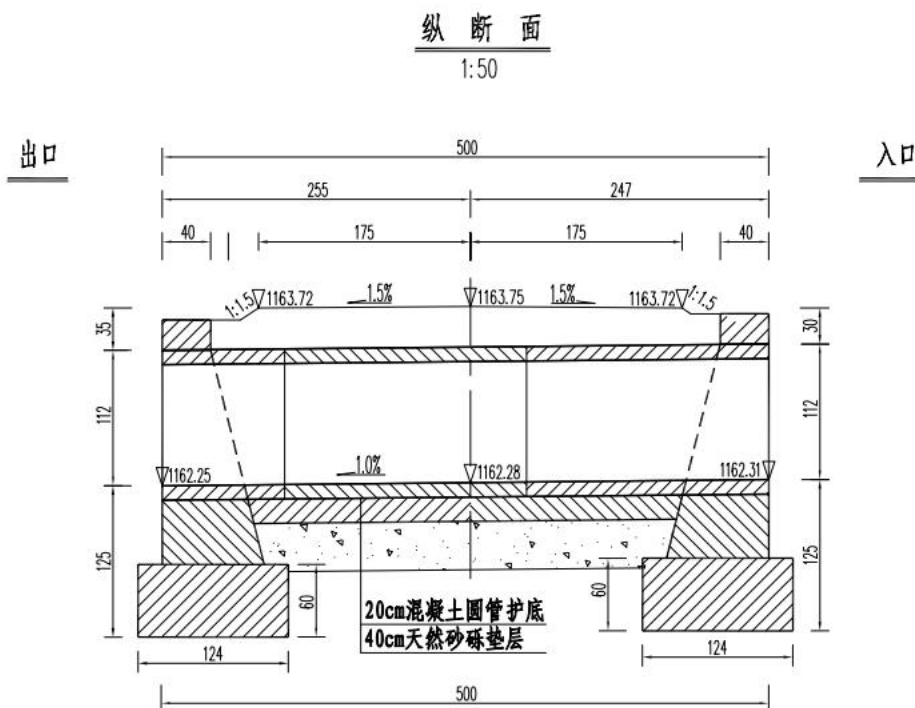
1-1.0m 钢混凝土圆管涵布置图
